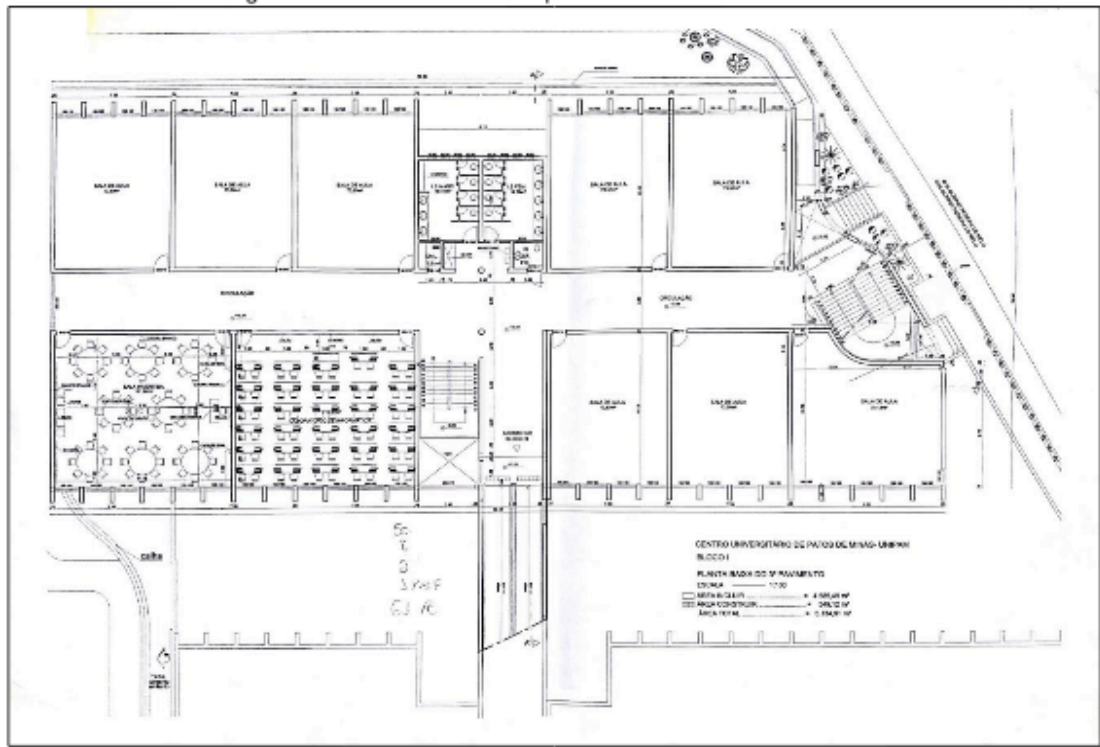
Planta baixa do 3º pavimento do bloco I do UNIPAM
